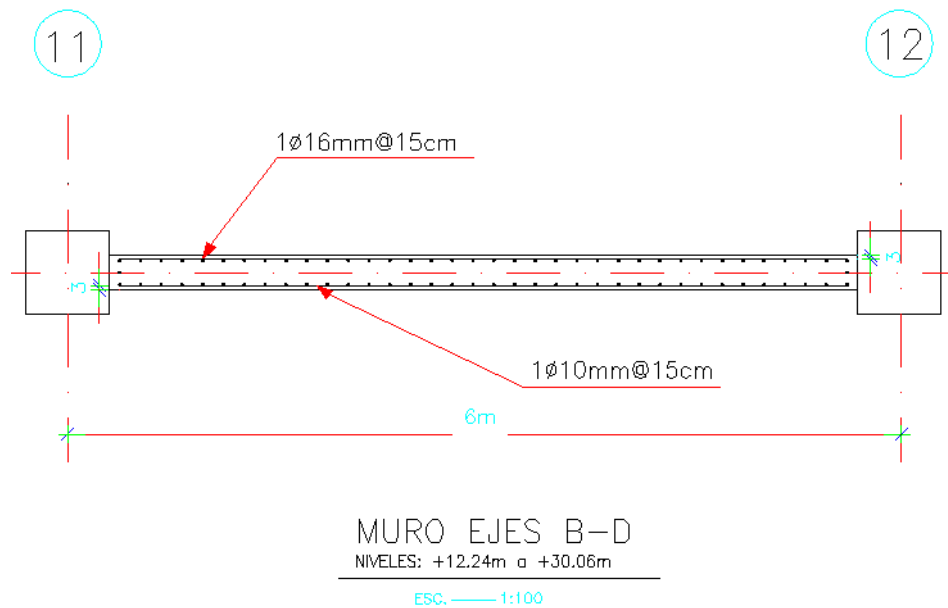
(a) Vista en elevación del muro a diseñarse.
